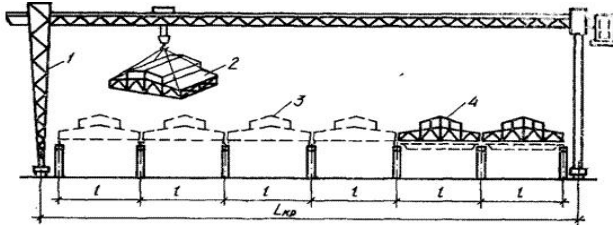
Схема установки козловых кранов при методе монтажа покрытий реконструируемого дока: 1 – козловой кран, 2 – объемный блок покрытия, 3 – демонтируемые конструкции покрытия, 4 – блоки покрытия
